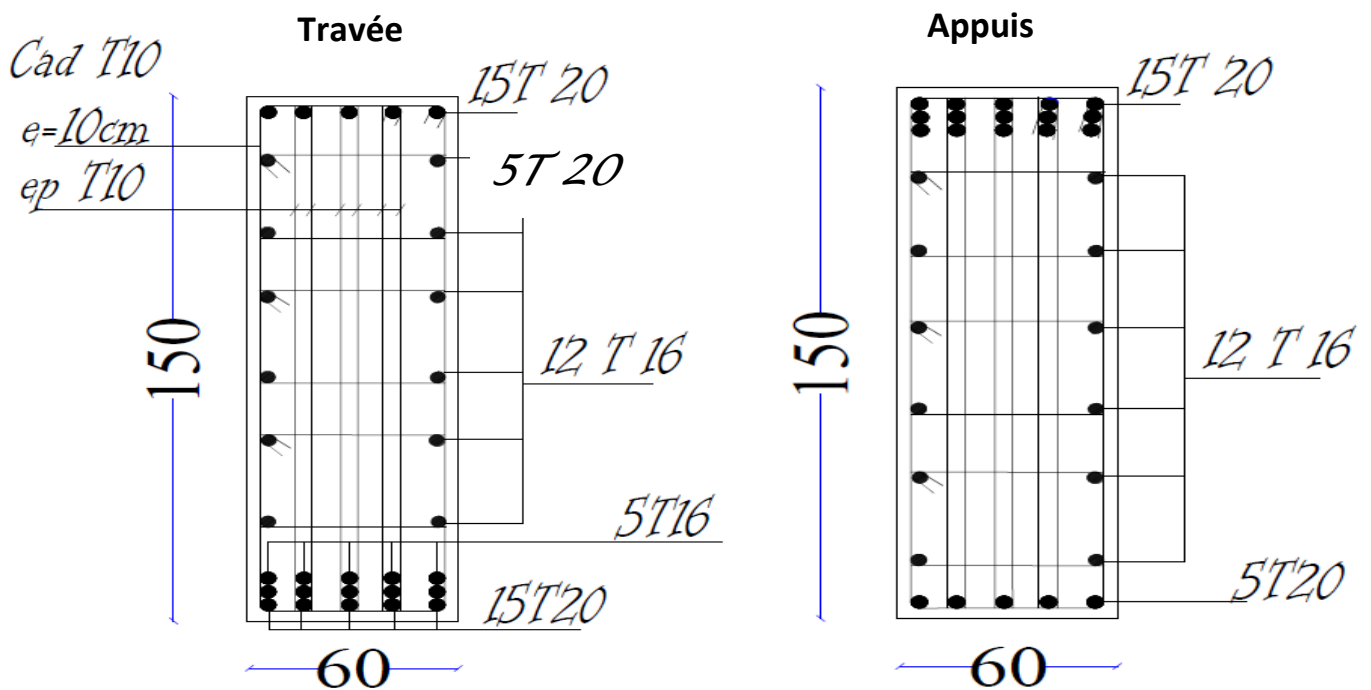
Ferrailage de la poutre Principale (150×60) cm²
